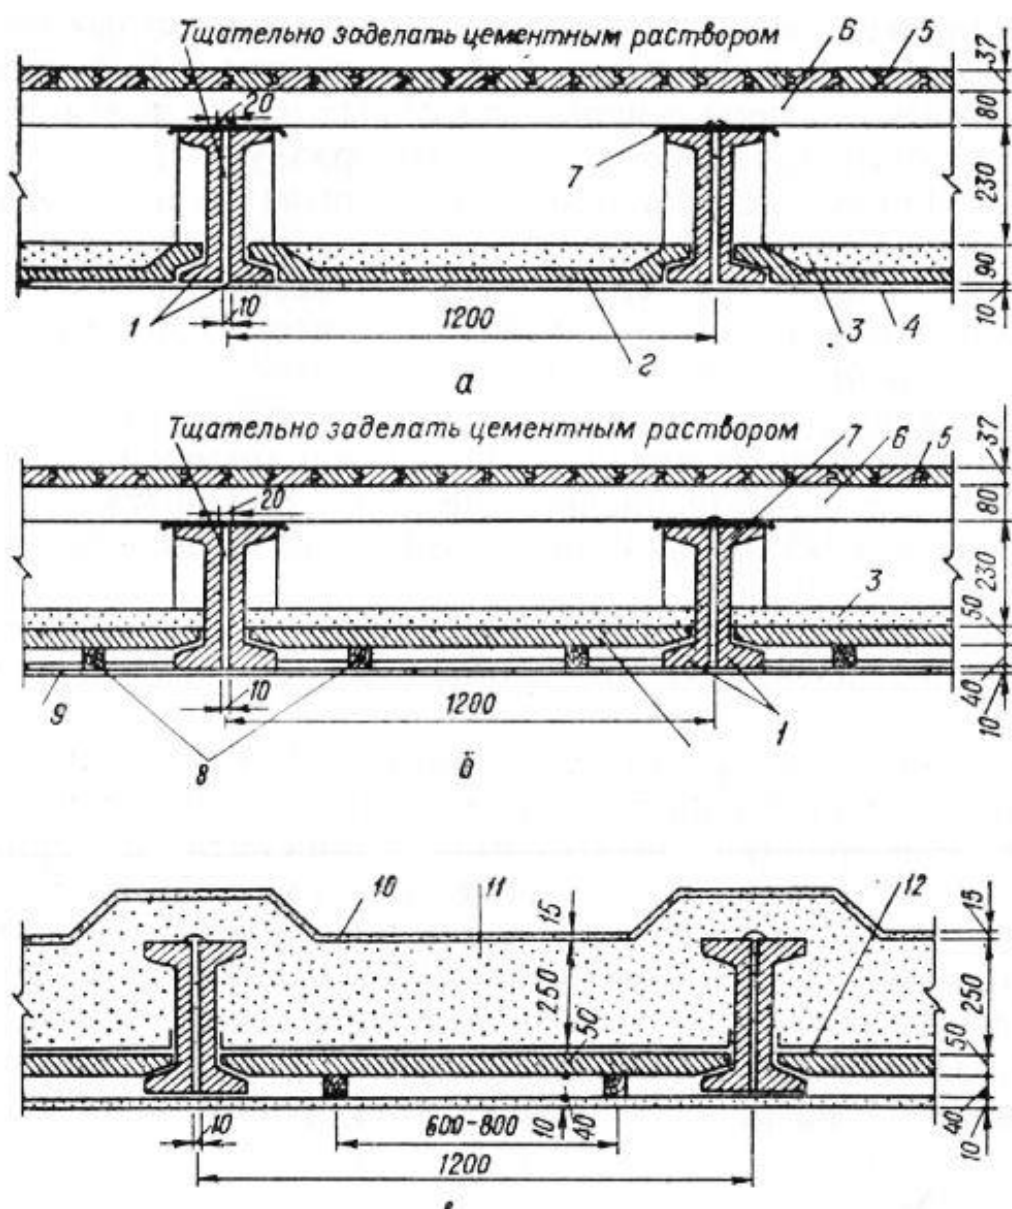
Московская конструкция сборного перекрытия из железобетонных швеллерных балок и плит с устройством пола:
